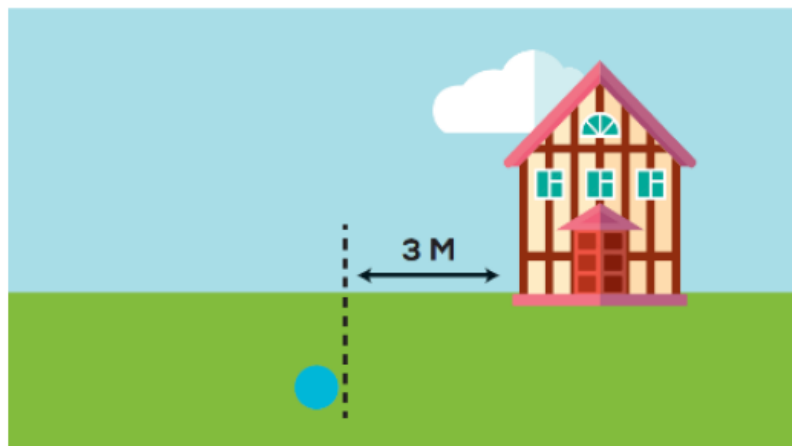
Principe du recul de 3m d'un ouvrage pluvial enterré
